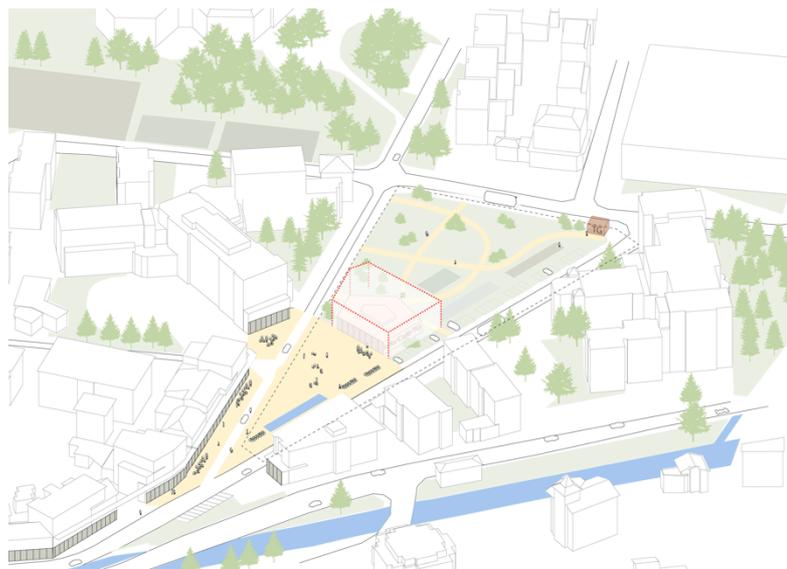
Piazza Rosatsch mit Klein-/Tiefbauten
